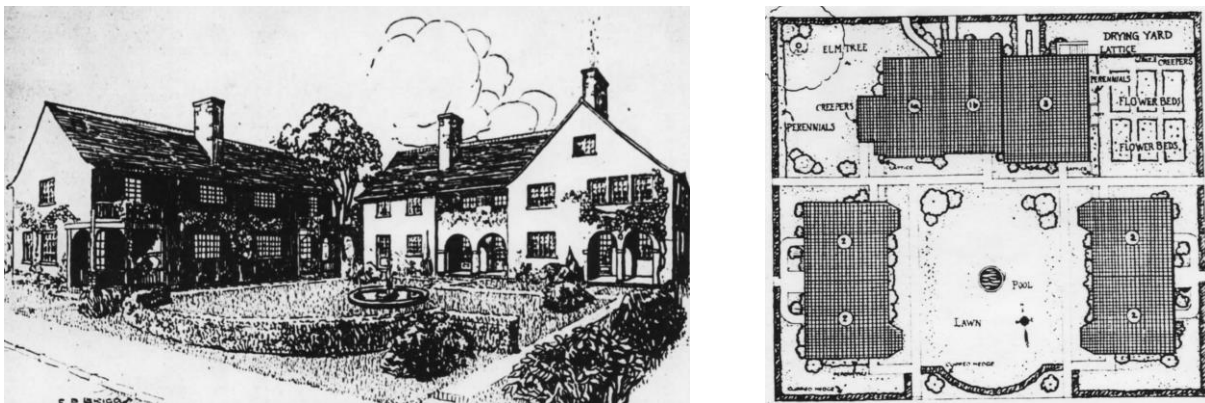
Wohnhausgruppe, Schaubild und Lageplan, um 1923.
